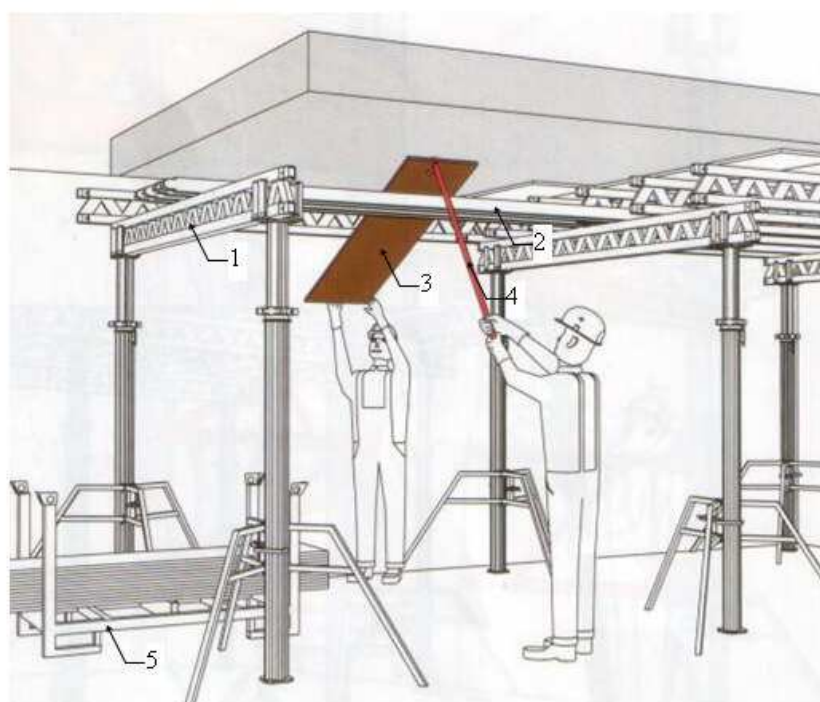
Демонтаж фанеры: 1 – продольная балка; 2 – поперечная балка сканованная «набок», 3 – демонтируемый лист фанеры; 4 – монтажная штанга; 5 – контейнер для складирования фанеры
